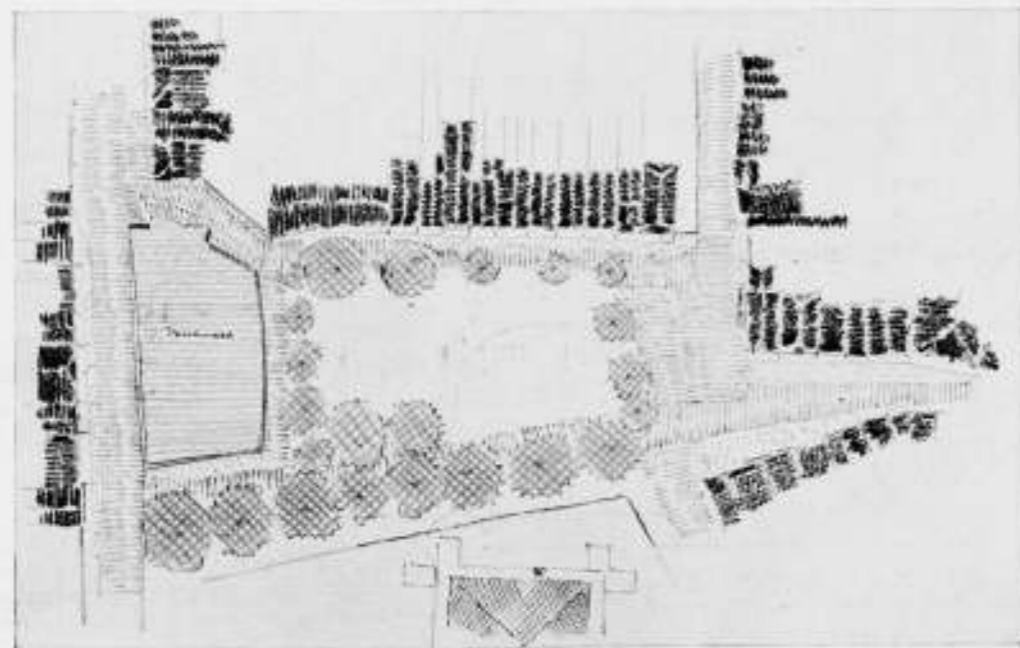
VOORPLEIN GESCHETST VAN AF DEN TOREN, TENEINDE BESTRATING, LOOPPADEN, BEPLANTING EN PARCELLEERING ONGEVEER VAST TE LEGGEN
